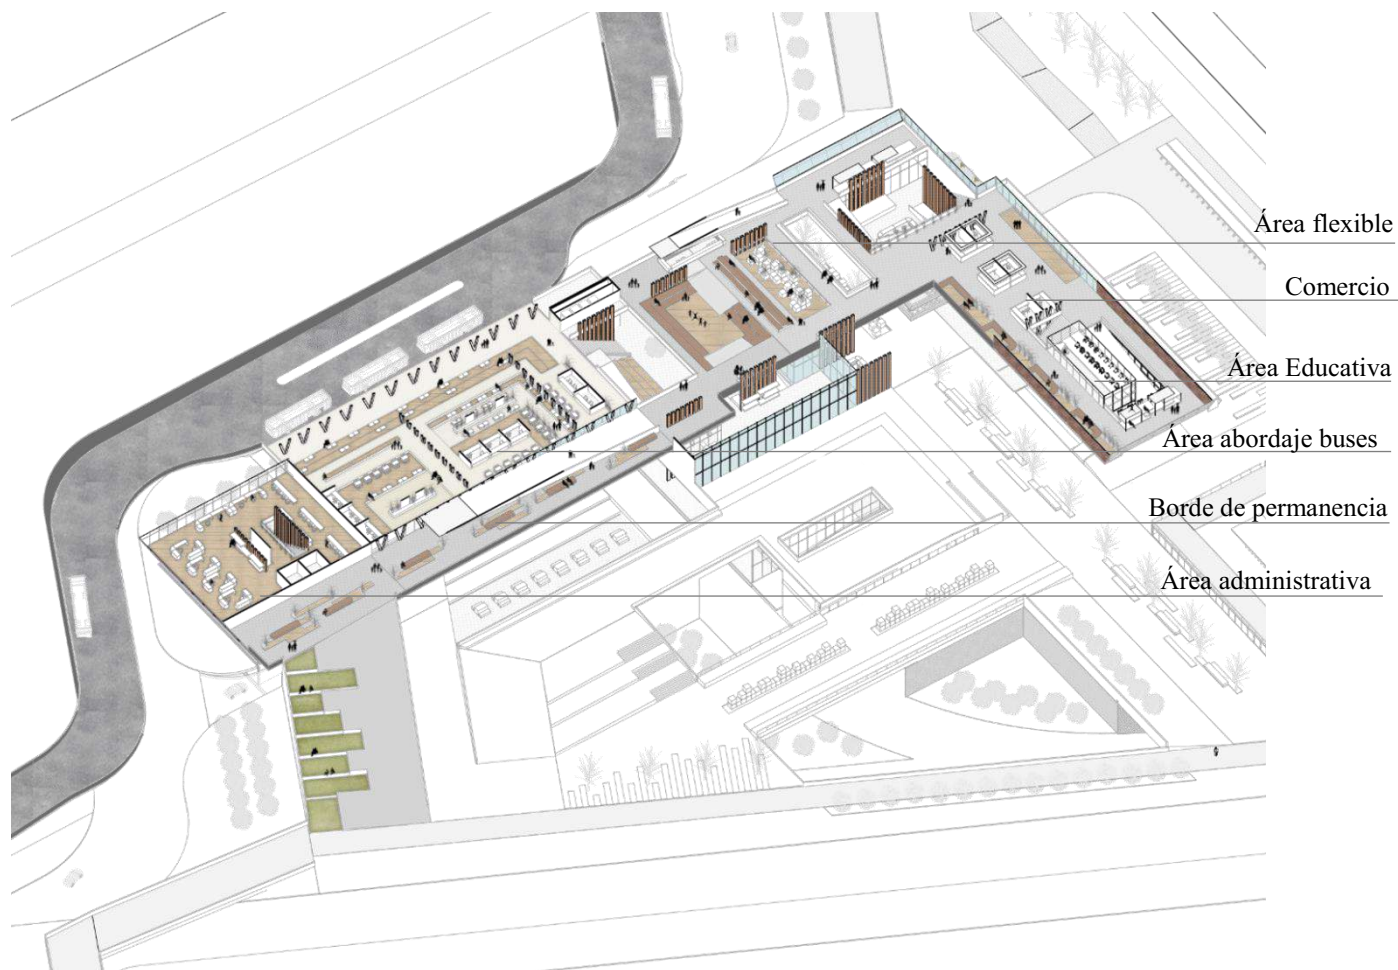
Planta axonometría segundo nivel. Elaboración propia.
